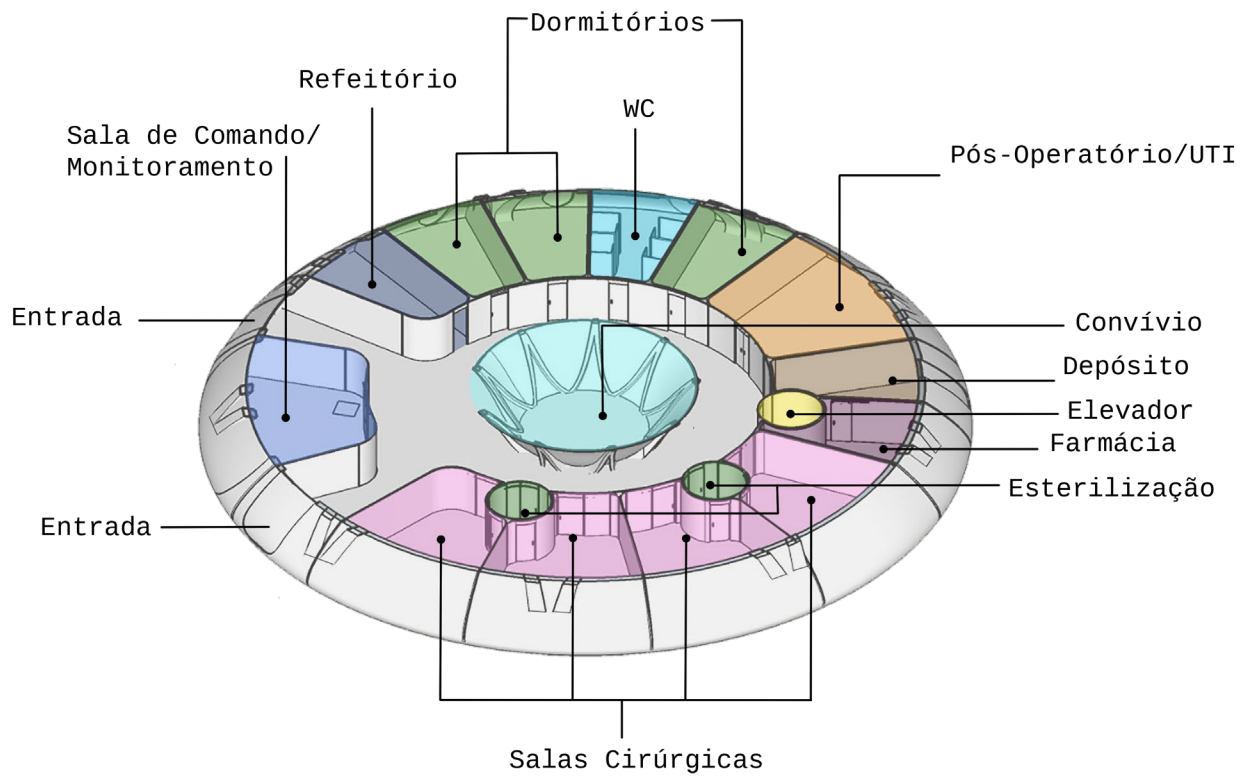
Layout Boiuna / Fonte: Produção autoral do grupo.
